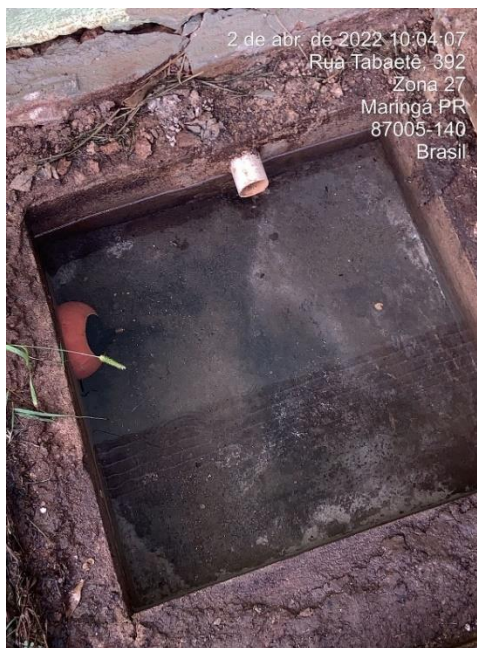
Vista de caixa de passagem com tubulação isolada para execução de teste de estanqueidade.
